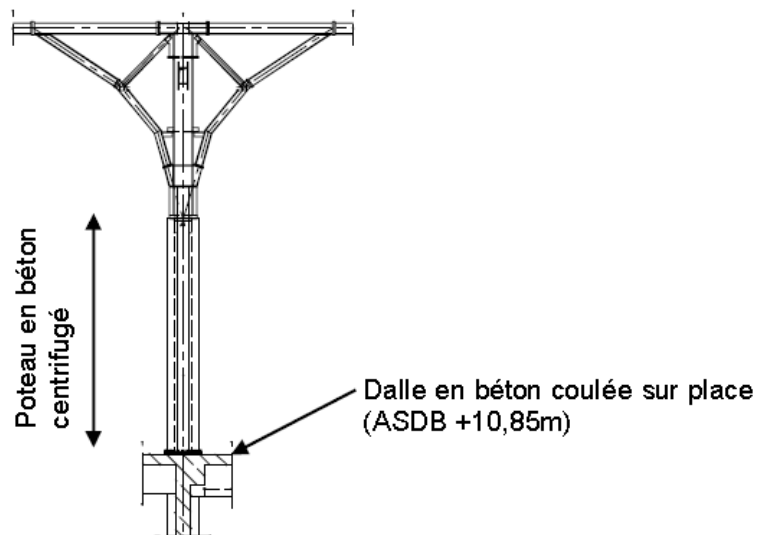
Structure d'un poteau de diamètre 81 cm – Type n° 2
